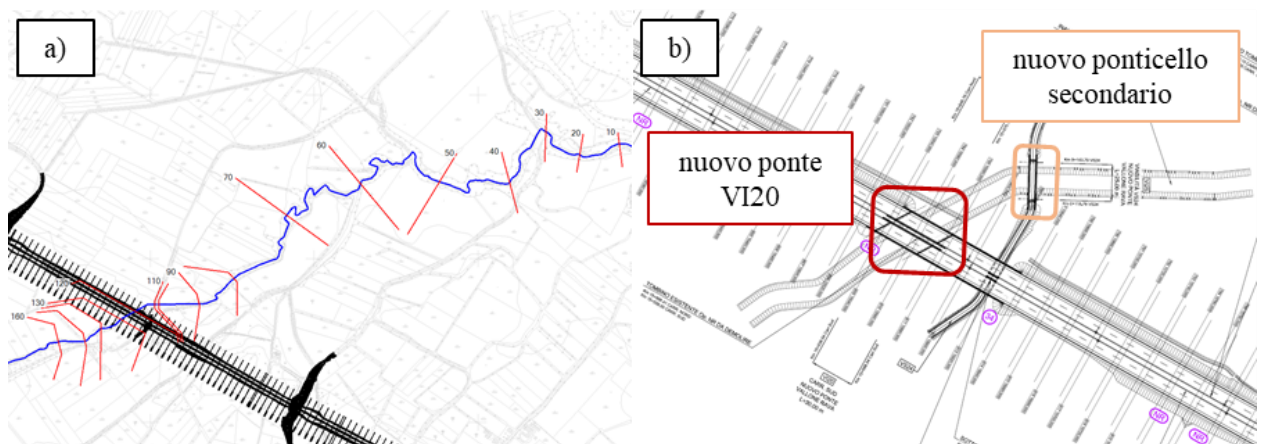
Inquadramento planimetrico della nuova opera VI20: a) sezioni modellate (planimetria modello idraulico), b) planimetria dell'inalveazione del vallone
